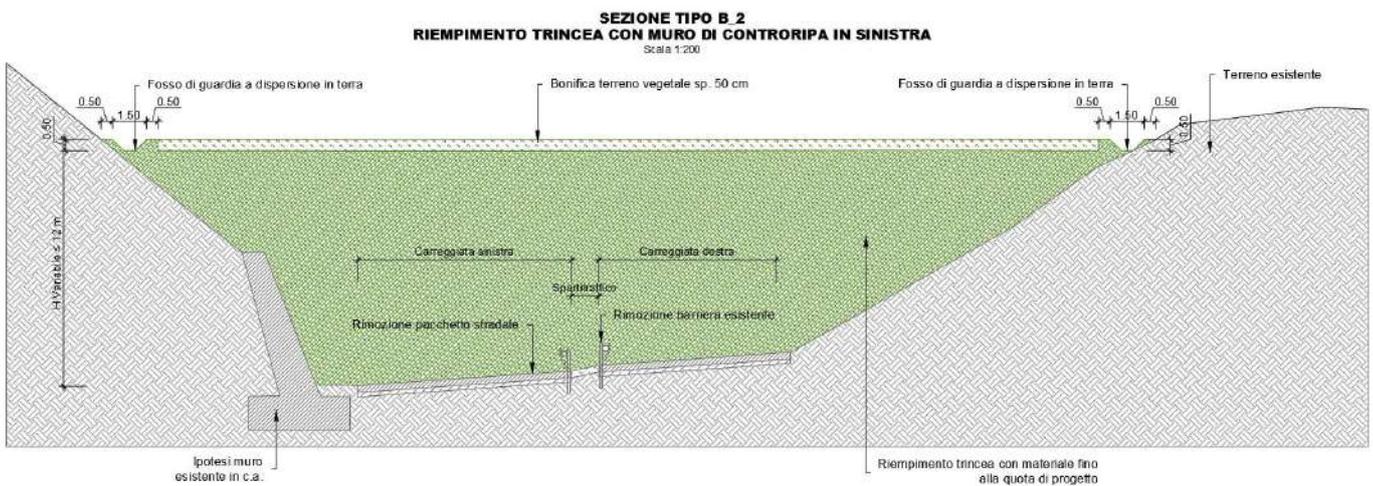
Sezione tipo B_2 riempimento trincea con muro in sinistra
